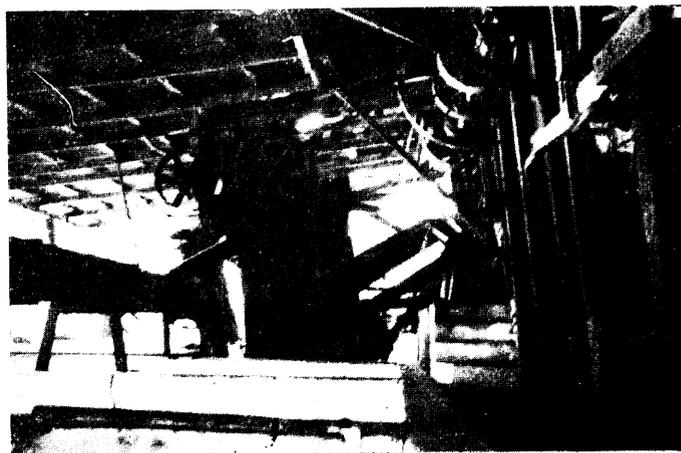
Beneficio «San José». Viguería de madera inclinada hacia el oriente.
